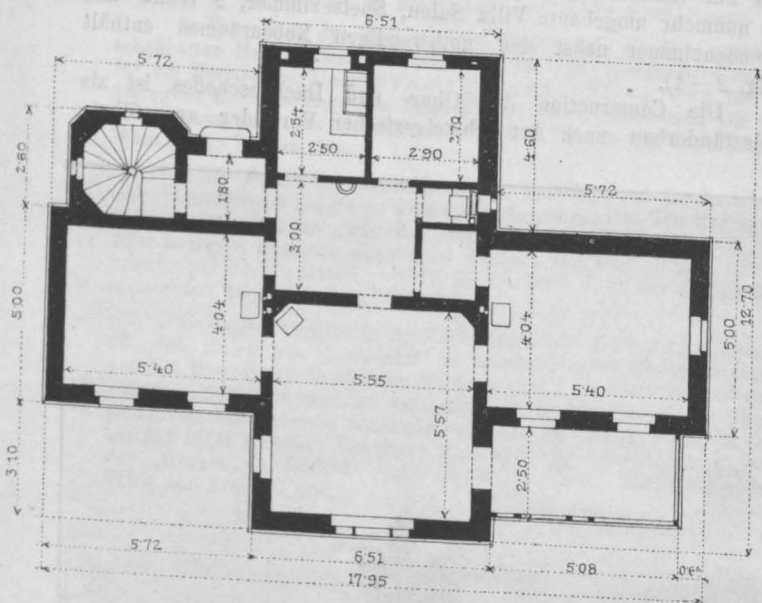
Parterre-Grundriss des alten Bestandes.
